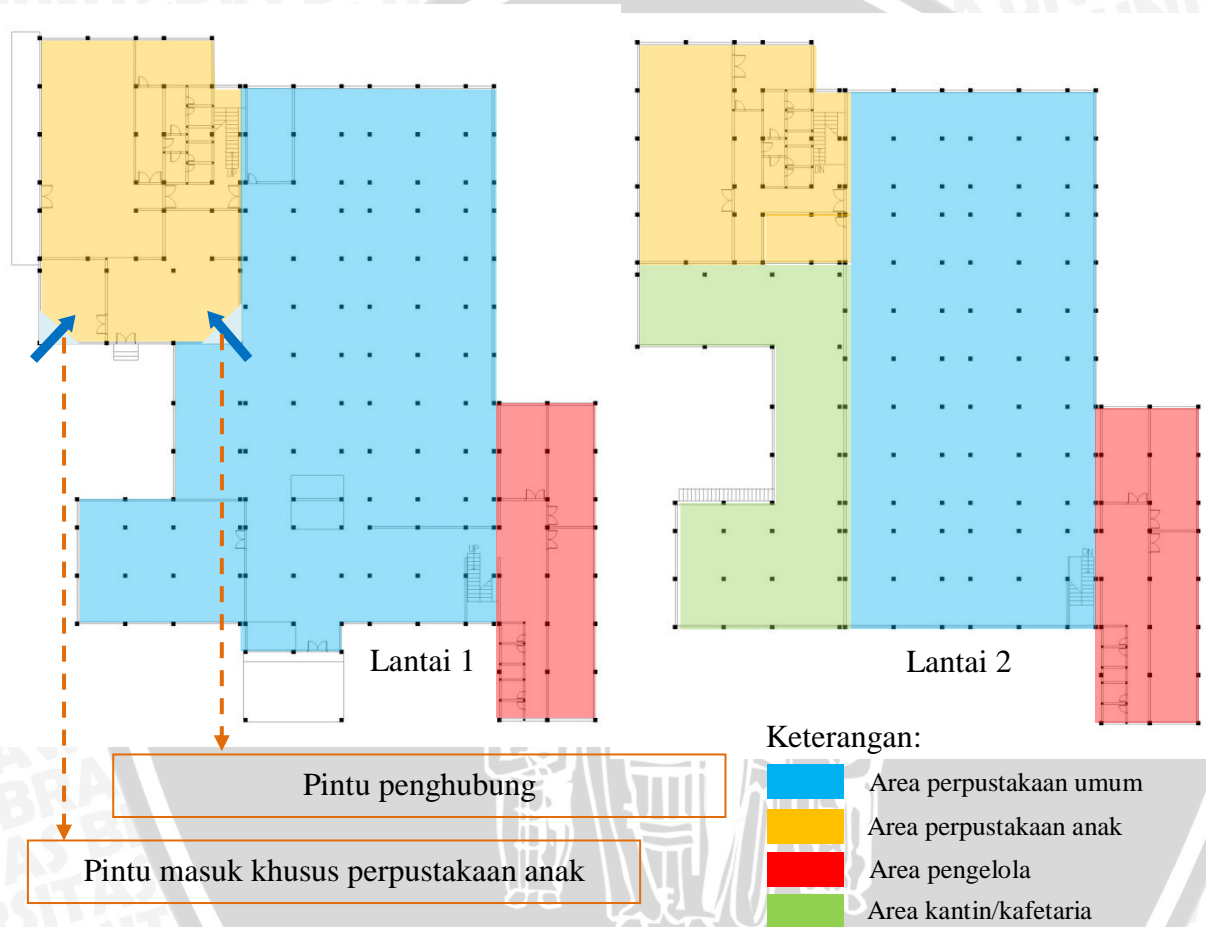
Aksesibilitas dan Sirkulasi Ruang Makro Eksisting
